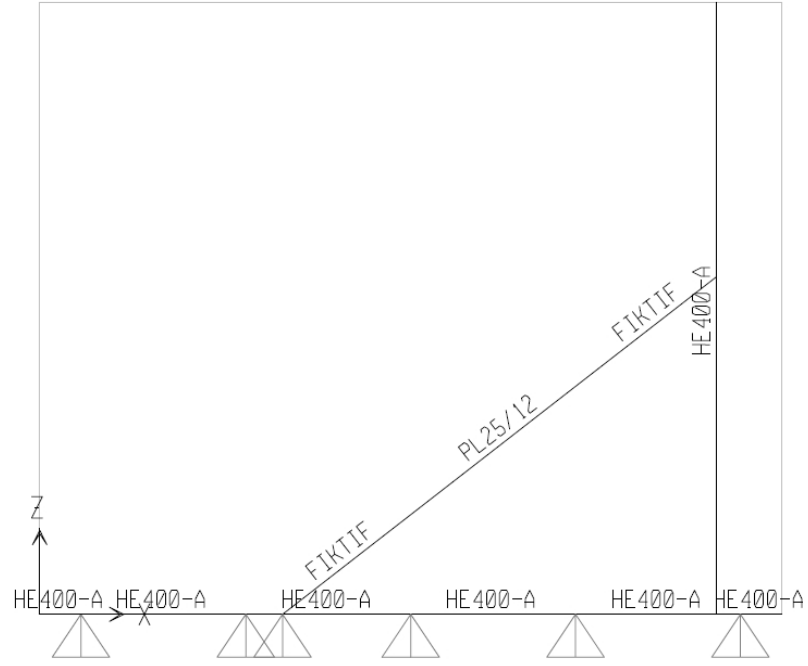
Laboratuvardaki kolon ve kiriş kesiti.
